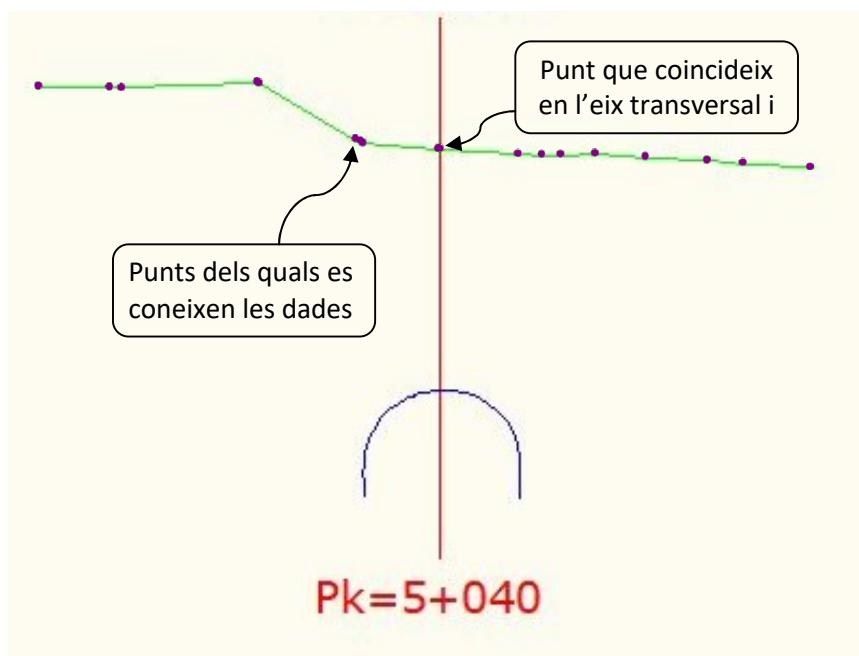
Exemple de perfil transversal (és un dels perfils amb els que s'ha treballat)
